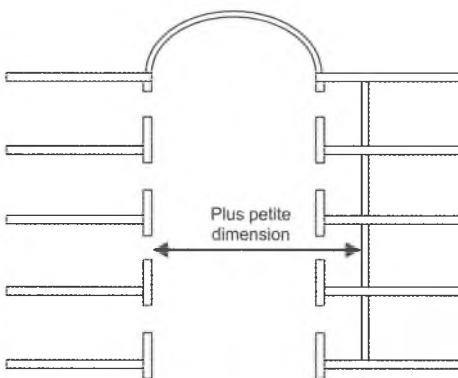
Atrium ouvert sur une face fermé sur l'autre
